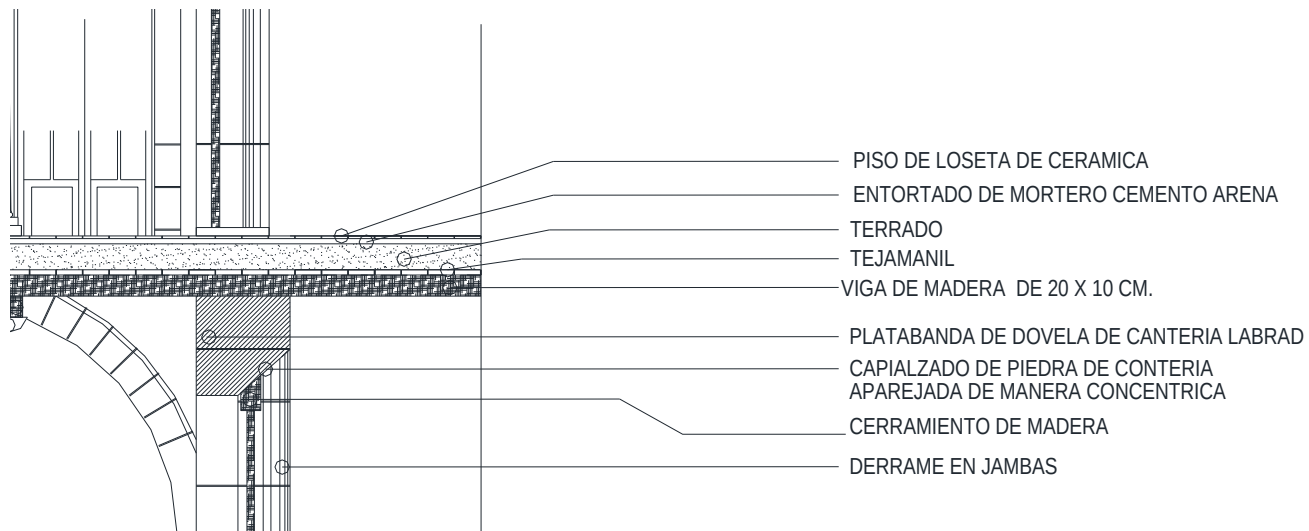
En este esquema se presenta el sistema constructivo de las losas de entrepiso del inmueble. (Elaboro: José A. Morales A.).
